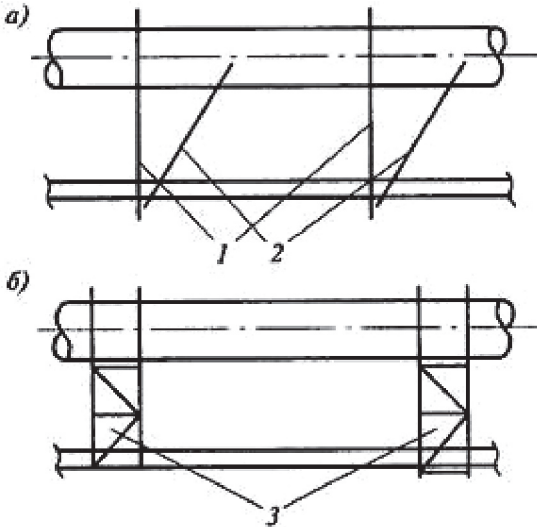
Подвеска сопутствующих трубопроводов:
